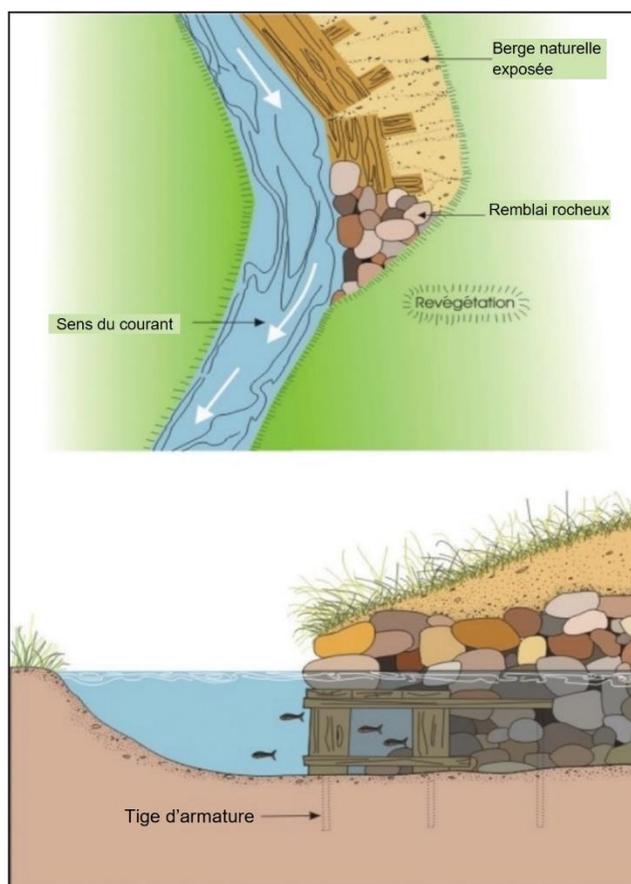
Vue aérienne (en haut) et vue latérale (en bas) de la technique de berge sous-cavée
